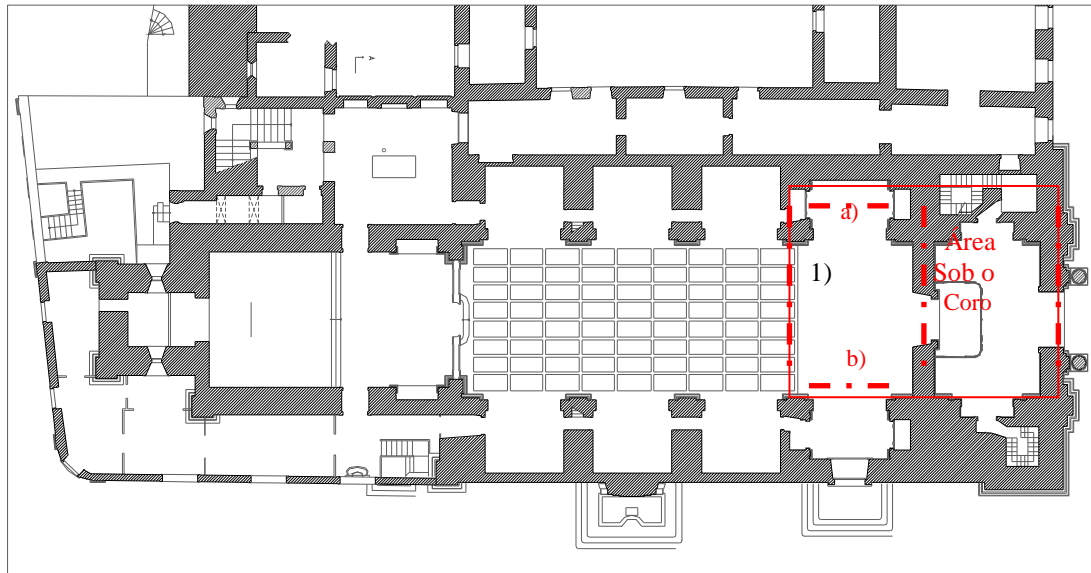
Planta do piso 0 da Igreja do Póculo. 1) Arco transversal de suporte do coro. a) e b) Arcos secundários, dispostos paralelamente ao desenvolvimento da nave.
